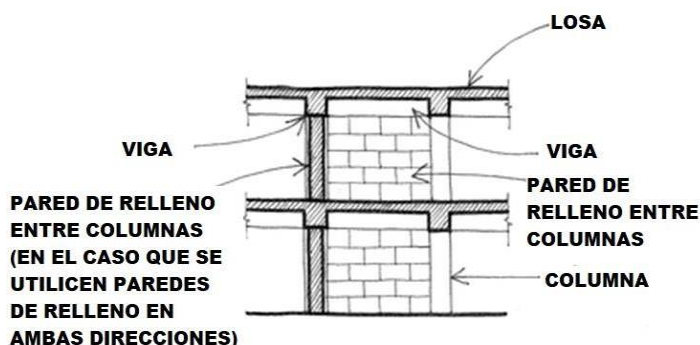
Típica práctica constructiva con pared de relleno de ladrillo.
